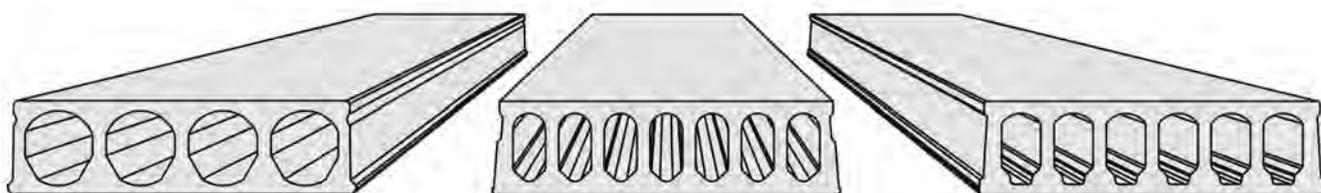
Примеры типовых форм пустотных плит перекрытия
